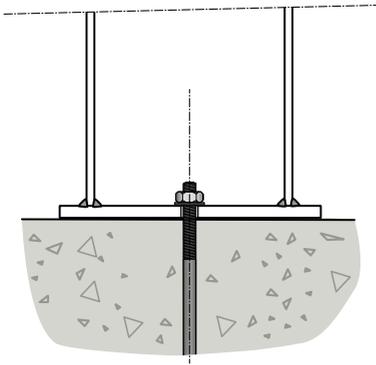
Pied de poteaux articulé, préparation avant coulage du béton
